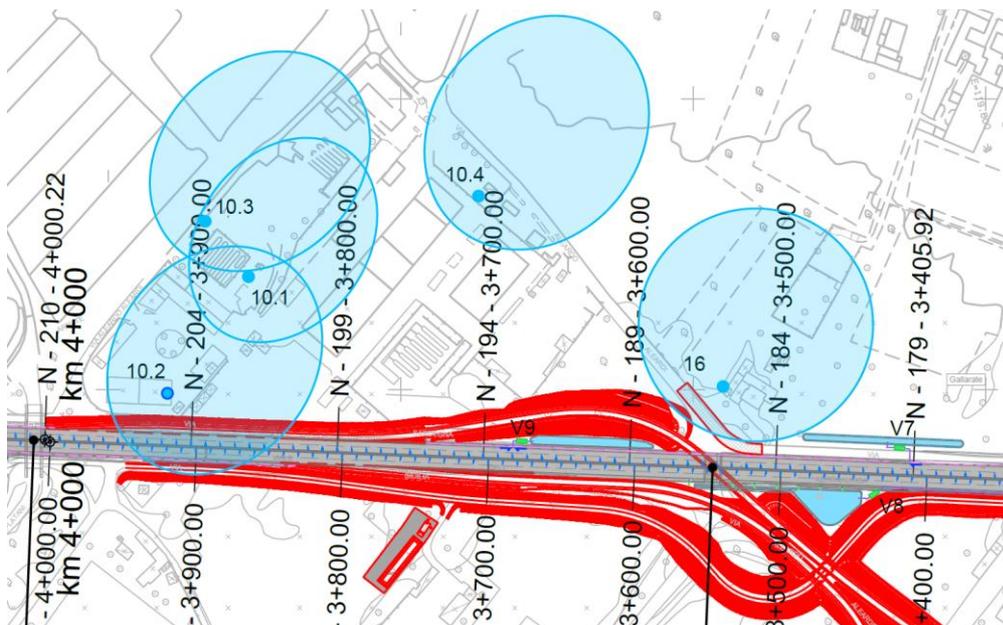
Stralcio Bretella di Gallarate rispetto ai pozzi individuati
